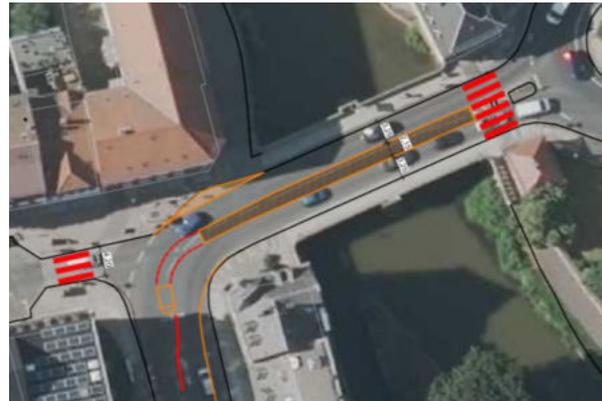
Lösungsvorschlag an der Oberbrücke zur Öffnung der Einbahnstraße und Querung der Kleinen Kirchgasse
